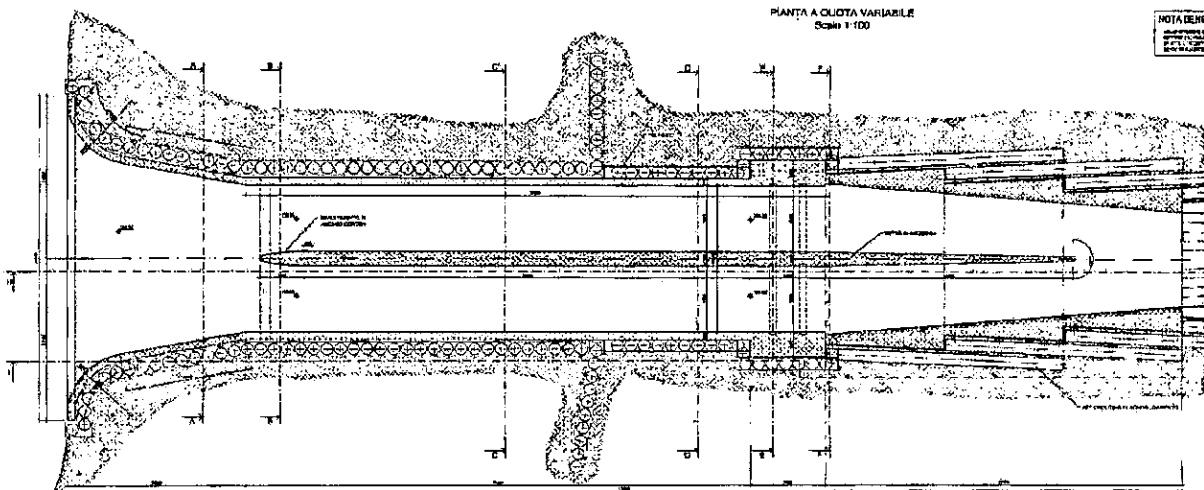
pianta imbocco galleria come da ultima proposta progettuale.
